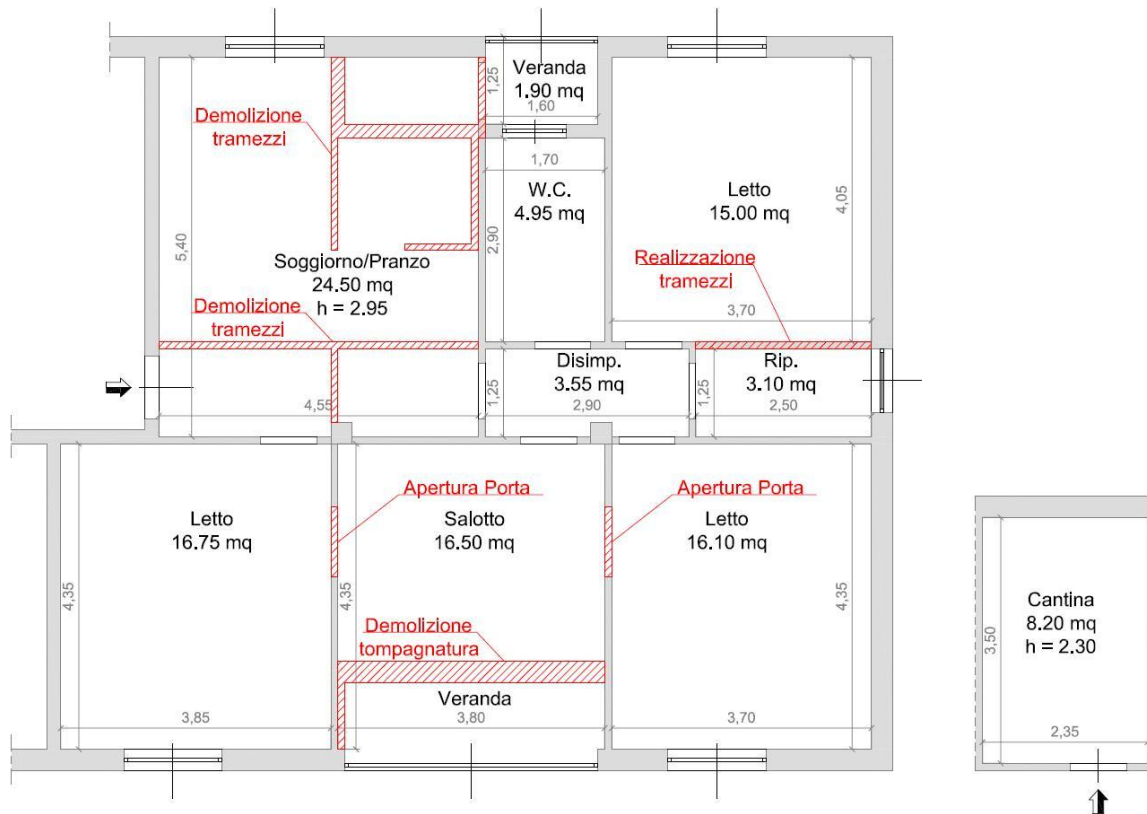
Planimetria Stato di fatto Foglio 29, p.lla 748, sub 45.
